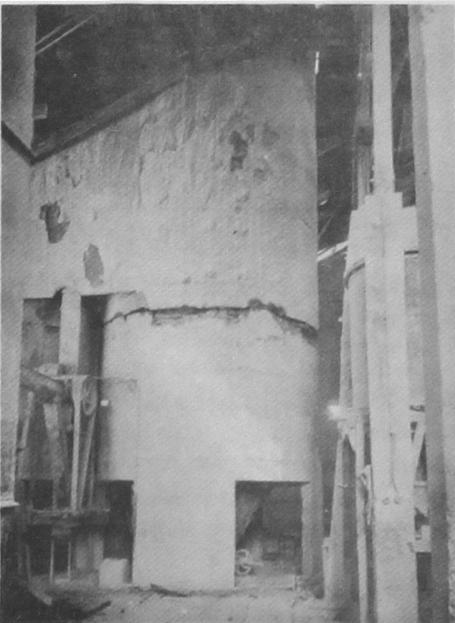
Junta de hormigonado fallada. Silo de la planta de yeso de El Volcán.
